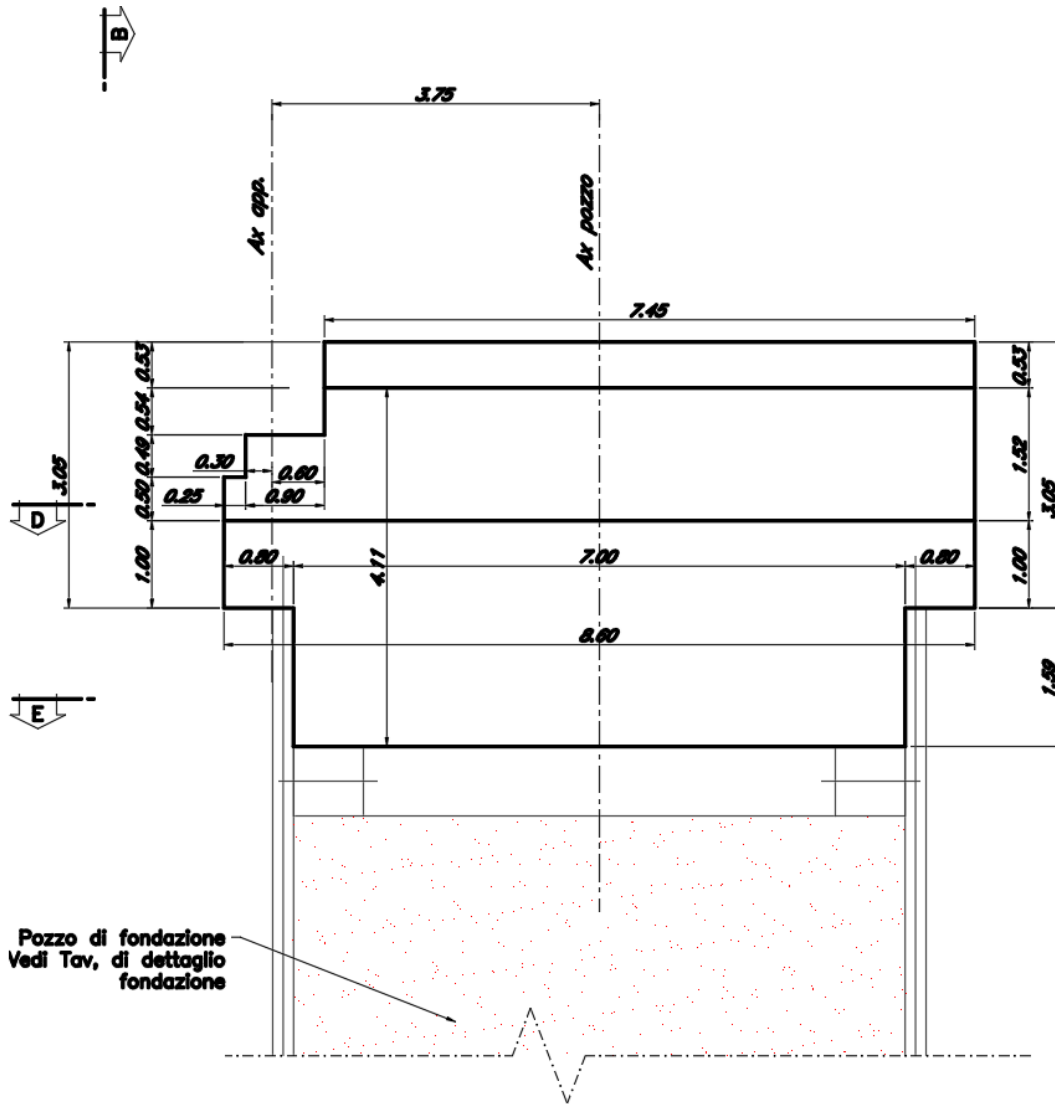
Prospetto Longitudinale Spalla B
